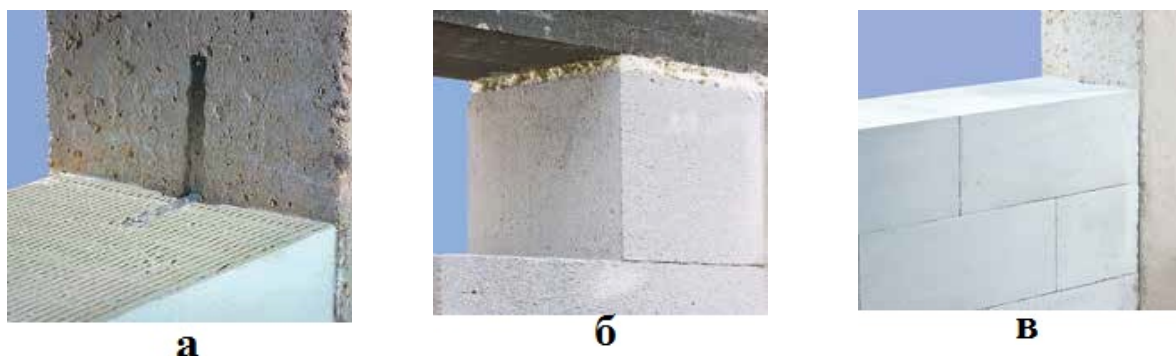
Примыкания стены: а — к железобетонной колонне; б — к железобетонному ригелю; в — к железобетонному каркасу
